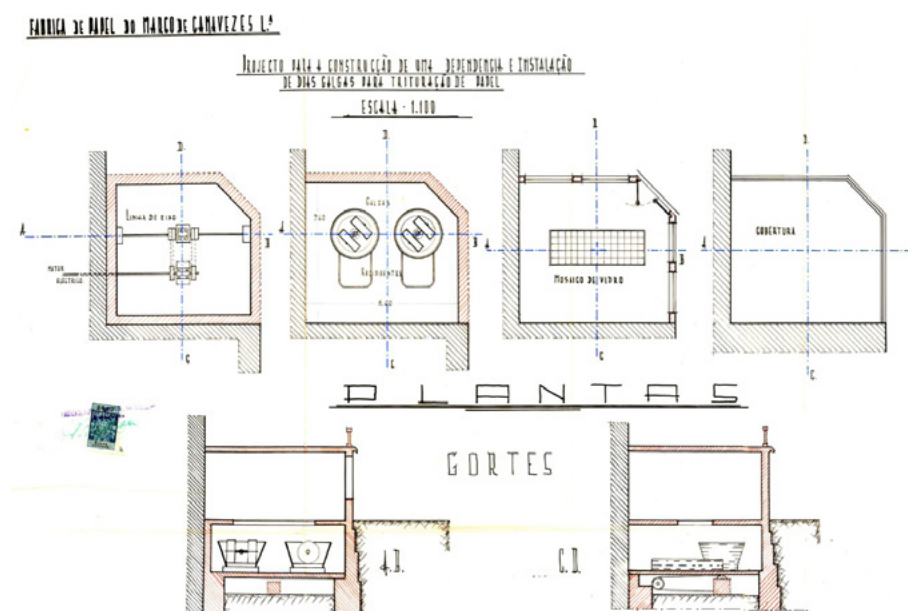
Plantas com o projecto para a construção de uma dependência para duas galgas para trituração de papel. Esc.: 1:100. Fonte: Arquivo APA.
